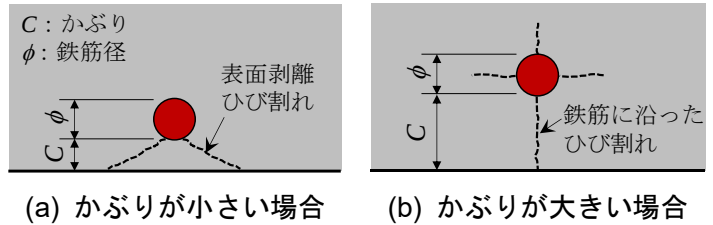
鉄筋の腐食ひび割れ発生モード
